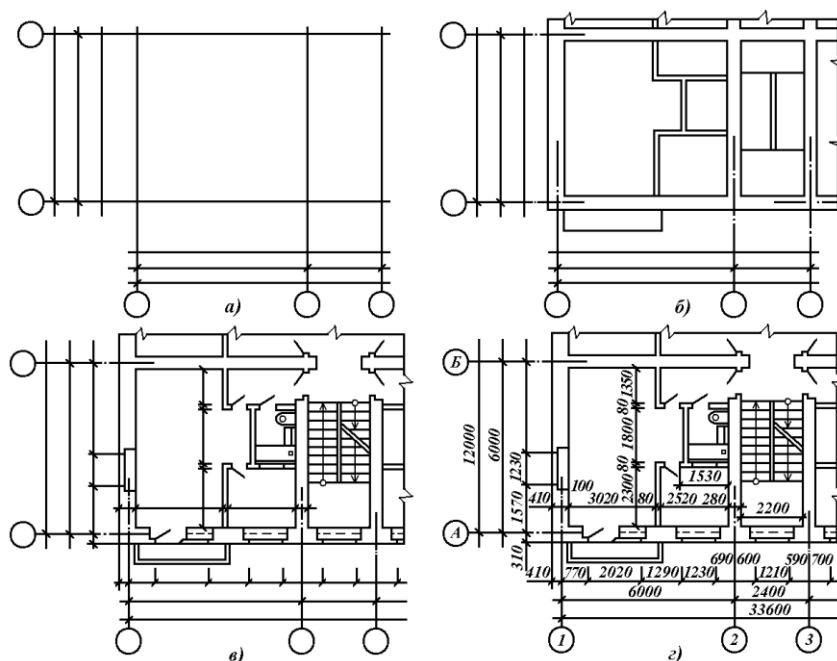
Послідовність (а..г) викреслювання плану будівлі
